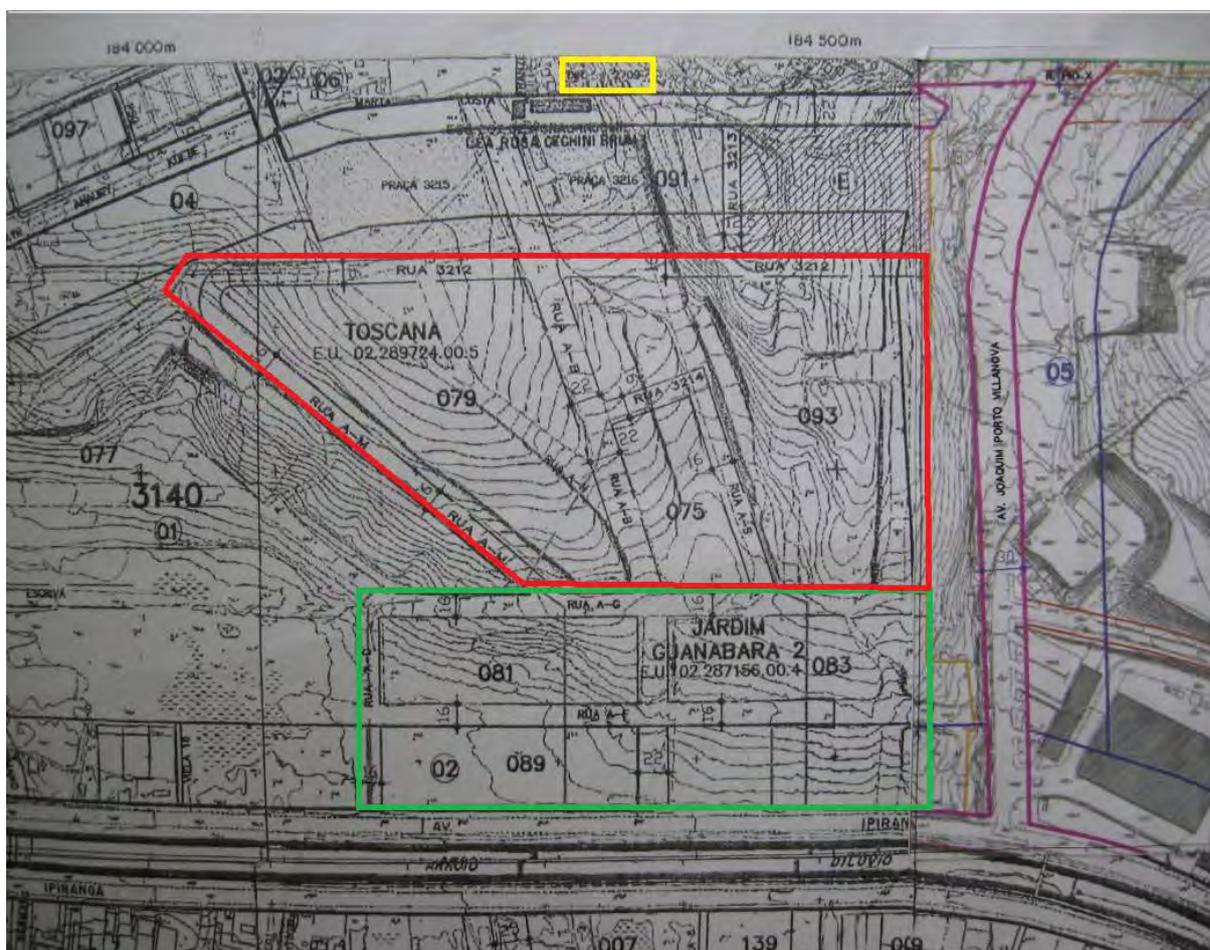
Planta dos terrenos do loteamento e Diretrizes Viárias. Fonte: SPM, 2011.
